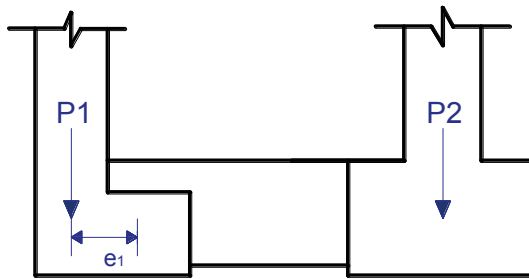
VISTA EN ELEVACIÓN DE ZAPATAS CONECTADAS.
